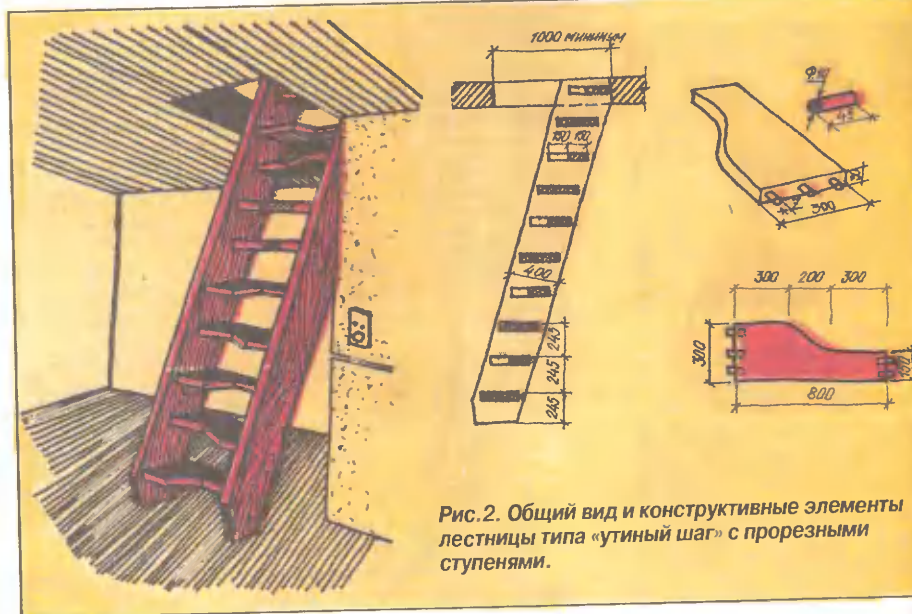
Общий вид и конструктивные элементы лестницы типа «утиный шаг» с прорезными ступенями.
